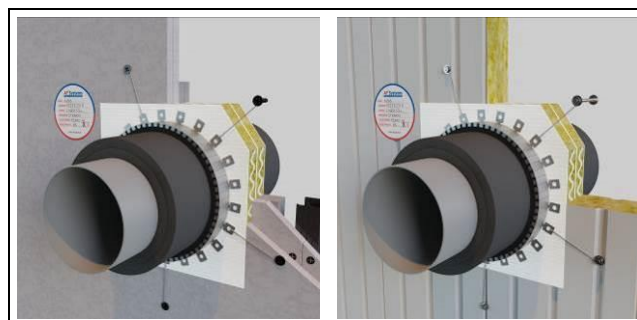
Ejemplo de sellado de tuberías metálicas aisladas (con AF MULTICOLLAR) en paredes.
